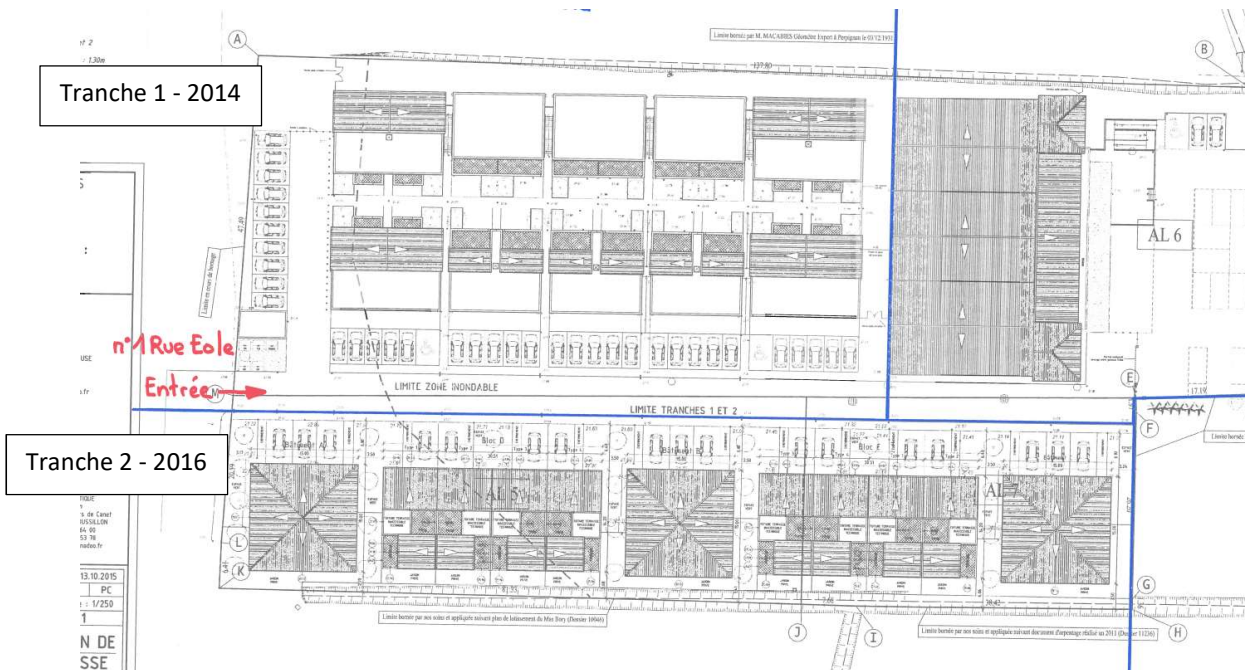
Plan Masse – Tranche 1 et 2 - 2016
